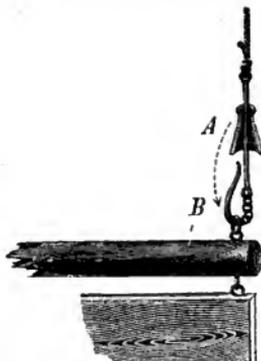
Springhaken zu Latirbretter (Thierärztl. Hochschule zu Mailand). A gusseiserner Glocke, welche behufs Verschluss über den Springhaken B gesteckt wird.
